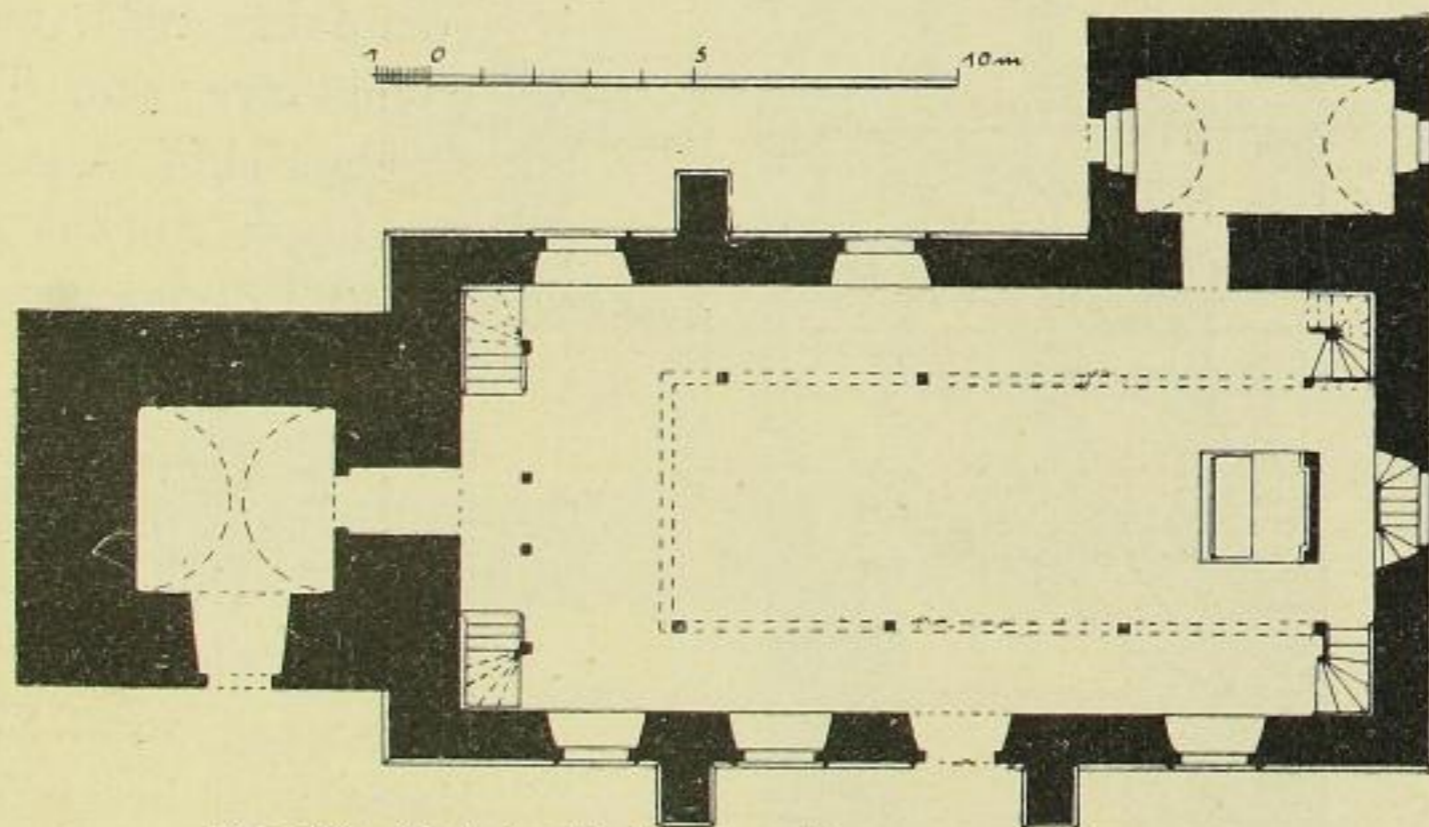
Weissig, Kirche, Grundriss. Zustand vor 1901.
